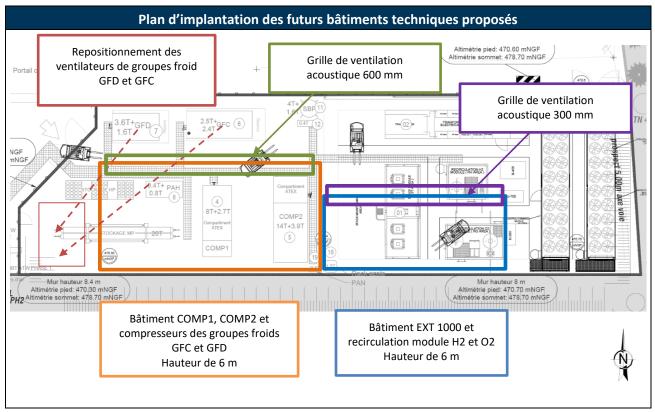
Plan d'implantation des futurs bâtiments techniques proposés
